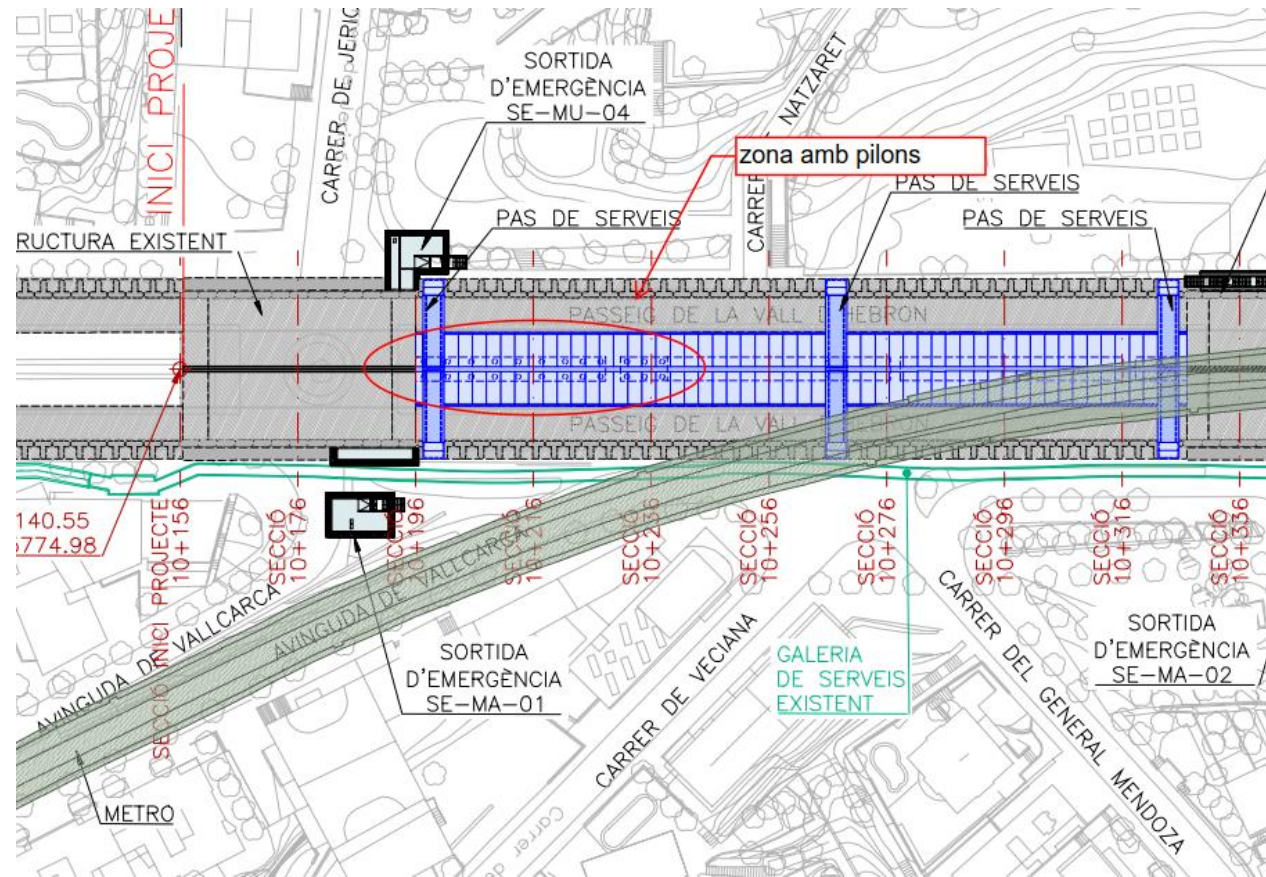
Planta amb el tram de mur amb fonamentació profunda a on no hi ha solapament amb el túnel
